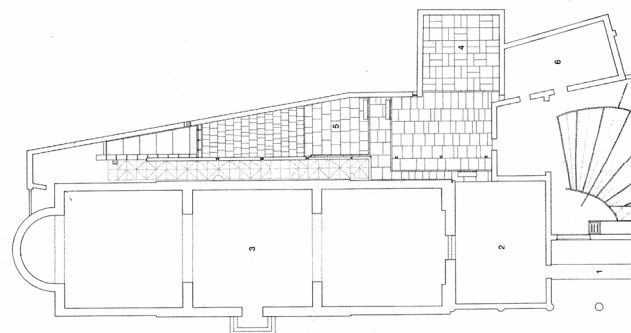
Gypsotheca Museo Canoviano, Grundriss Altbestand und Anbau von Carlo Scarpa, Possagno.
